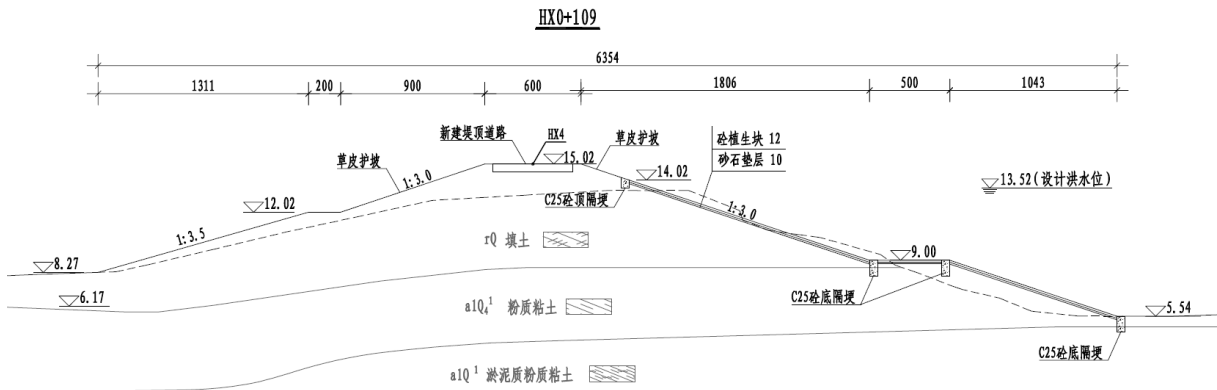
堤防加固典型横断面图（黄许河入江堤防）
